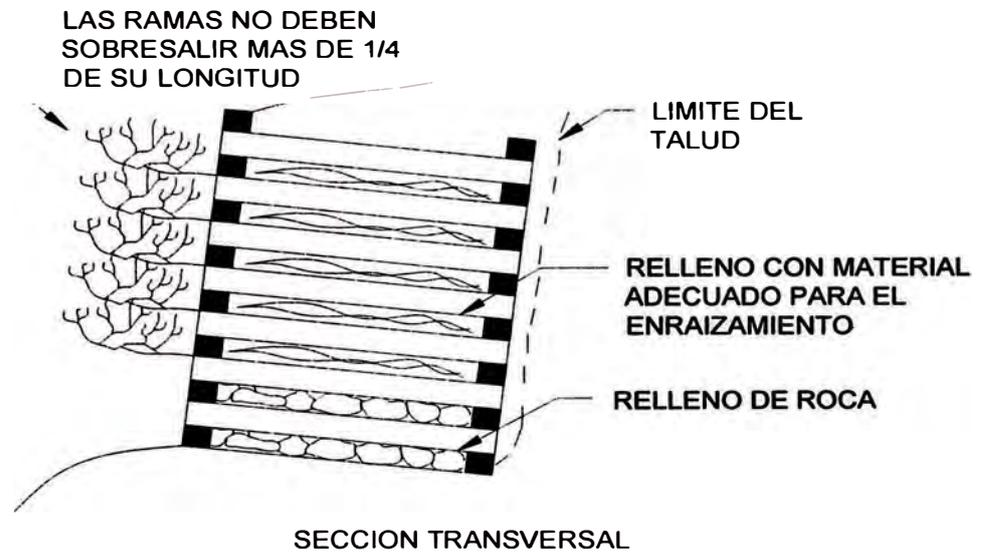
(c) : Muro Viviente – Detalles Constructivos
